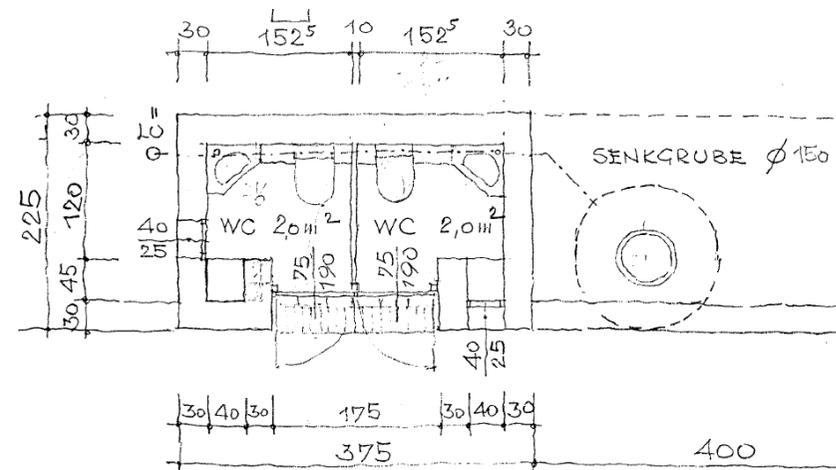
Einreichplan WC Vorkapfl Grundriss
